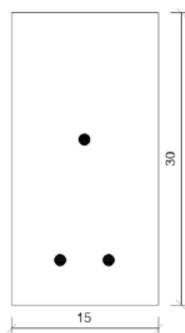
Corte transversal de uma viga estrutural ilustrado a azul na Figura 44
